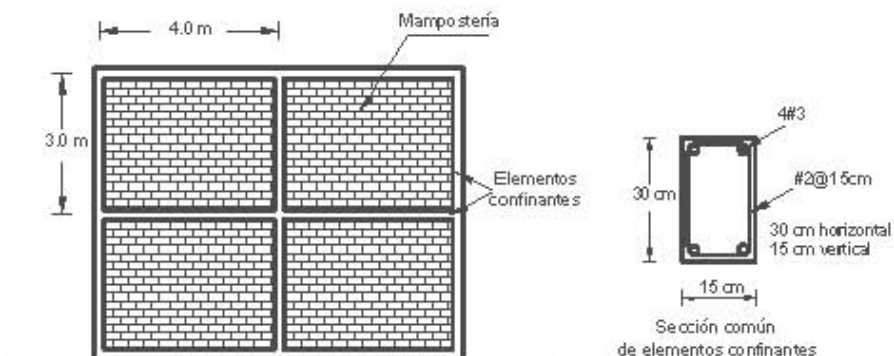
Arreglo común de muros de mampostería confinada (Aguilar et al., 1996)
